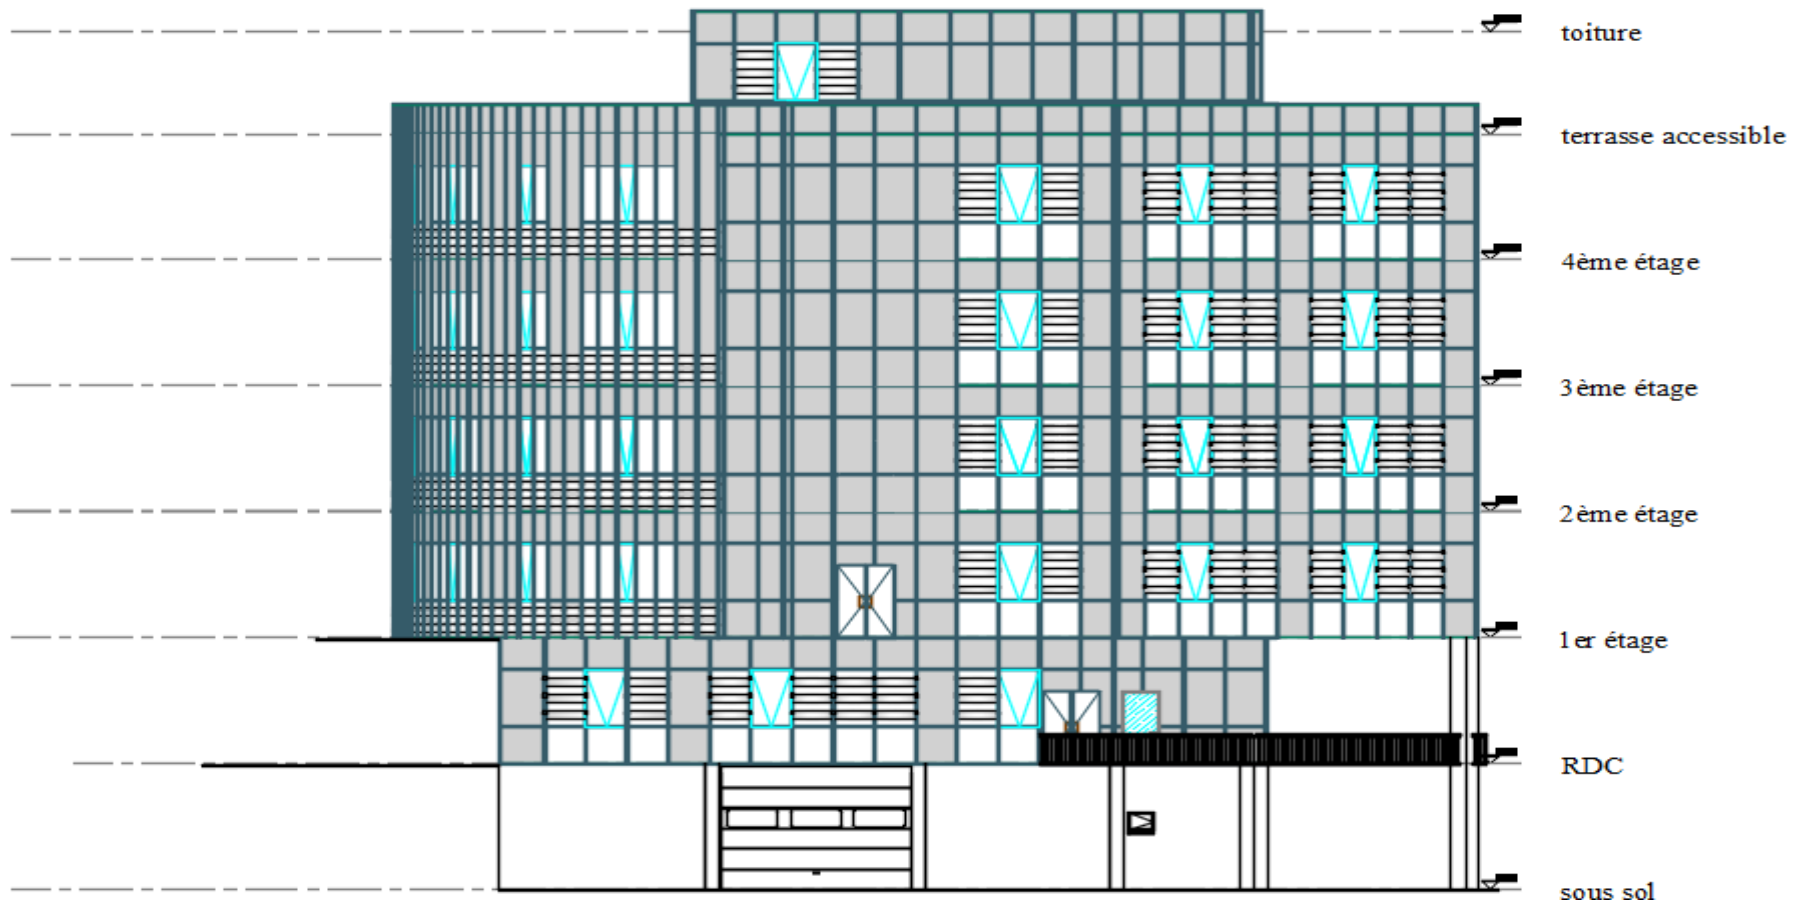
Plan d'architecture de la façade est (Autodesk Autocad)
